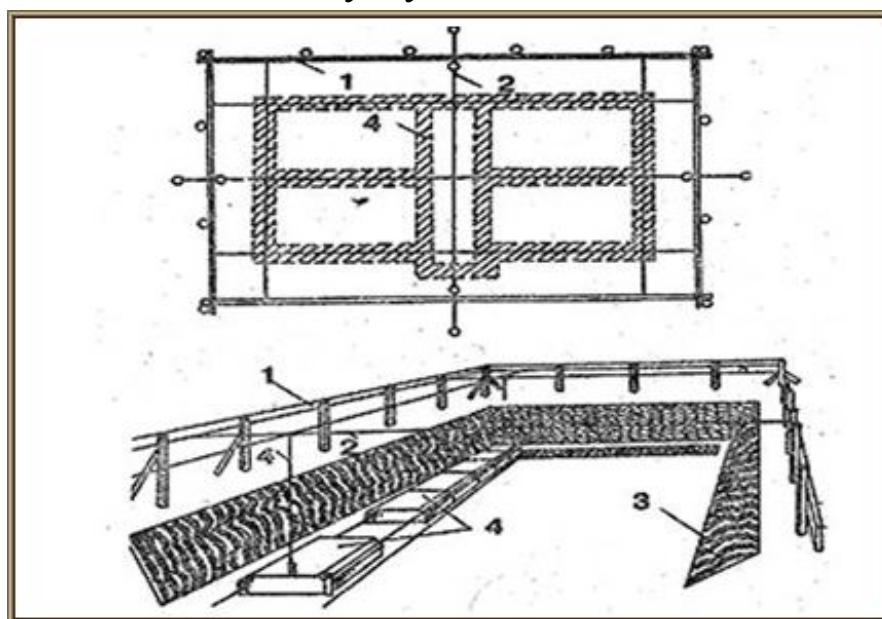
Разбивка котлована под ленточный фундамент:
